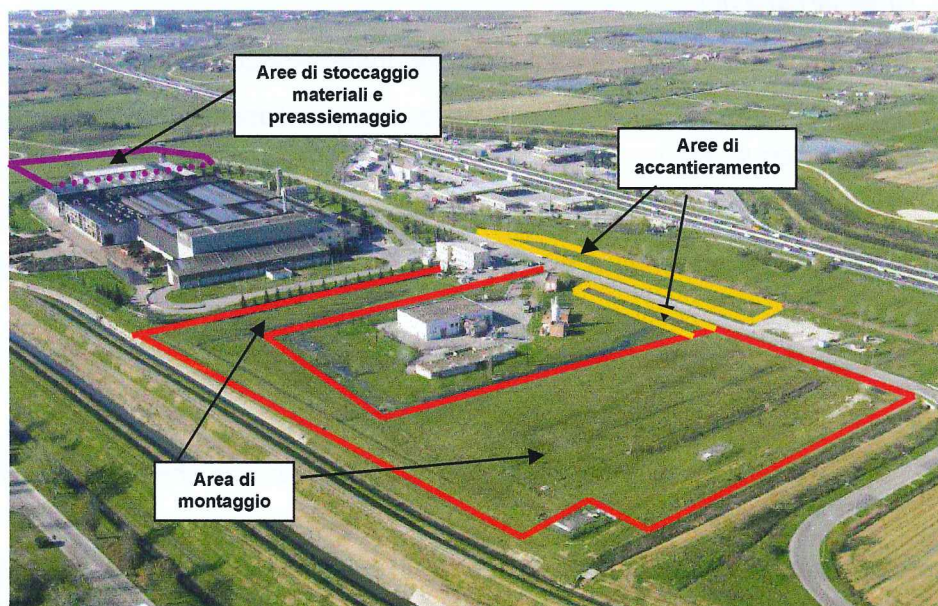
Suddivisione delle zone di cantiere all'interno dell'area di localizzazione dell'impianto
